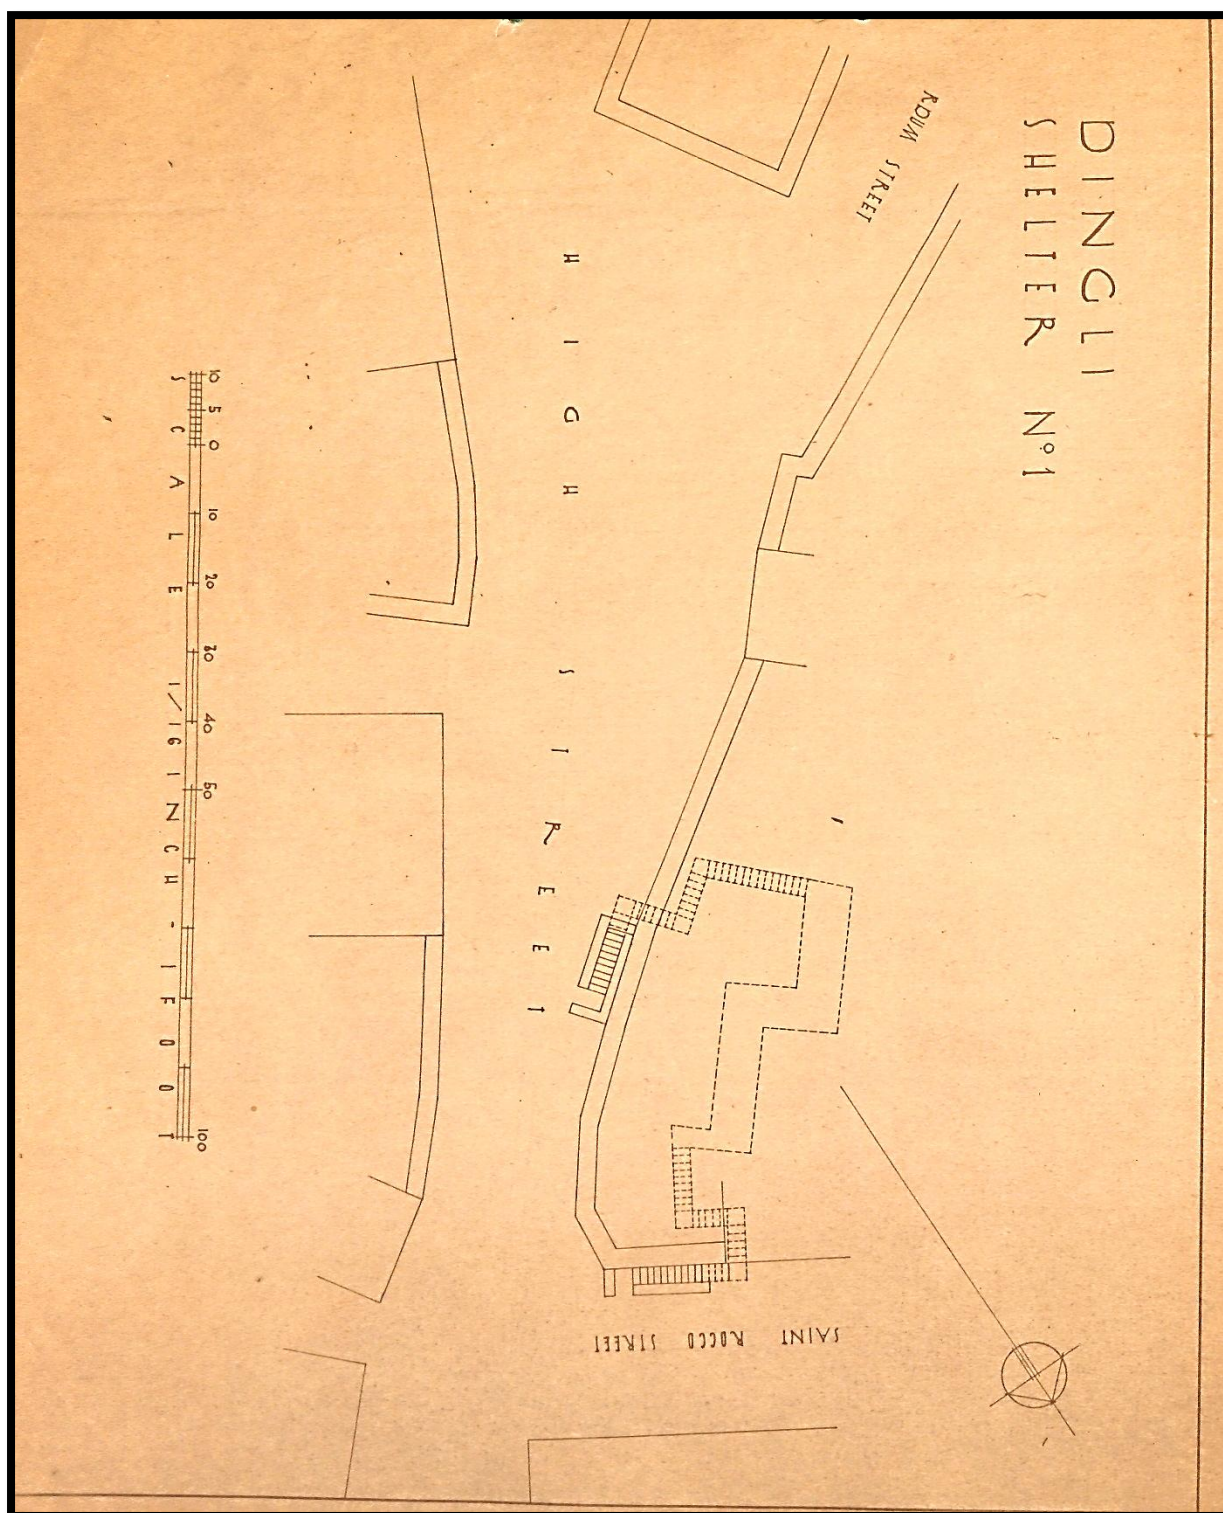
Planta do Abrigo nº 1 "High Street – Saint Rocco Street – Ruum Strada."
